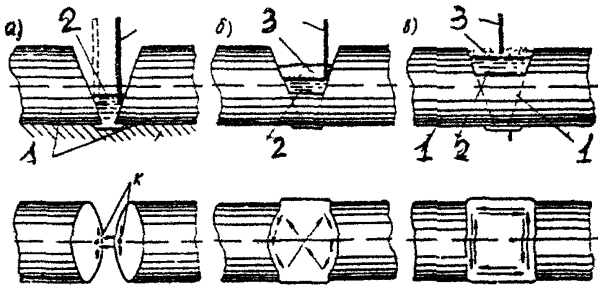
Техника ванной сварки под флюсом стыковых соединений горизонтальных стержней
